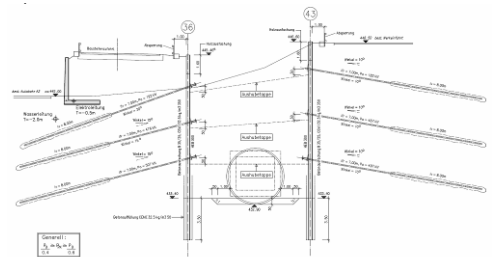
Baugrube Lochhof mit Portalwand in aufgeschüttetem Tunnelausbruch (Höhe: 14 m)
